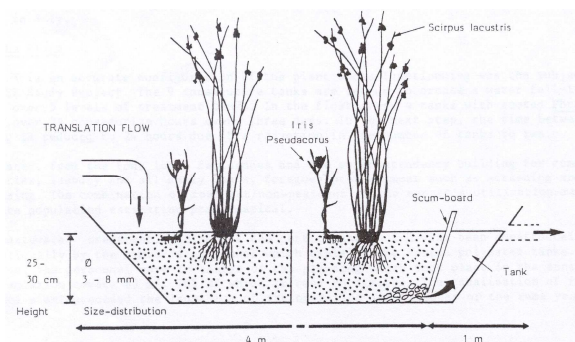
Coupe longitudinale d'un filtre en translation ou à "écoulement horizontal" à St Bohaire
